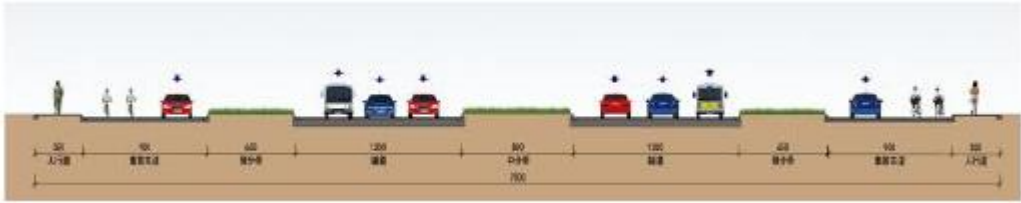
北环路（开放大道西侧）现状道路标准横断面图
